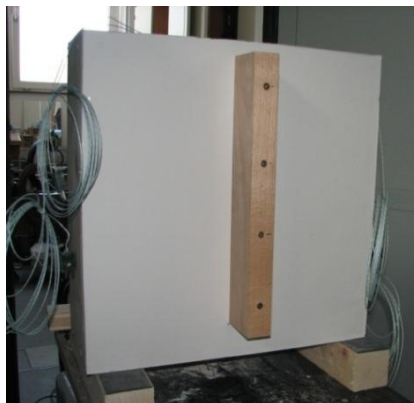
Konstruktionsdetails: Probekörper mit Rahmenelement aus unbeschichtetem Buchenholz [INO09]
